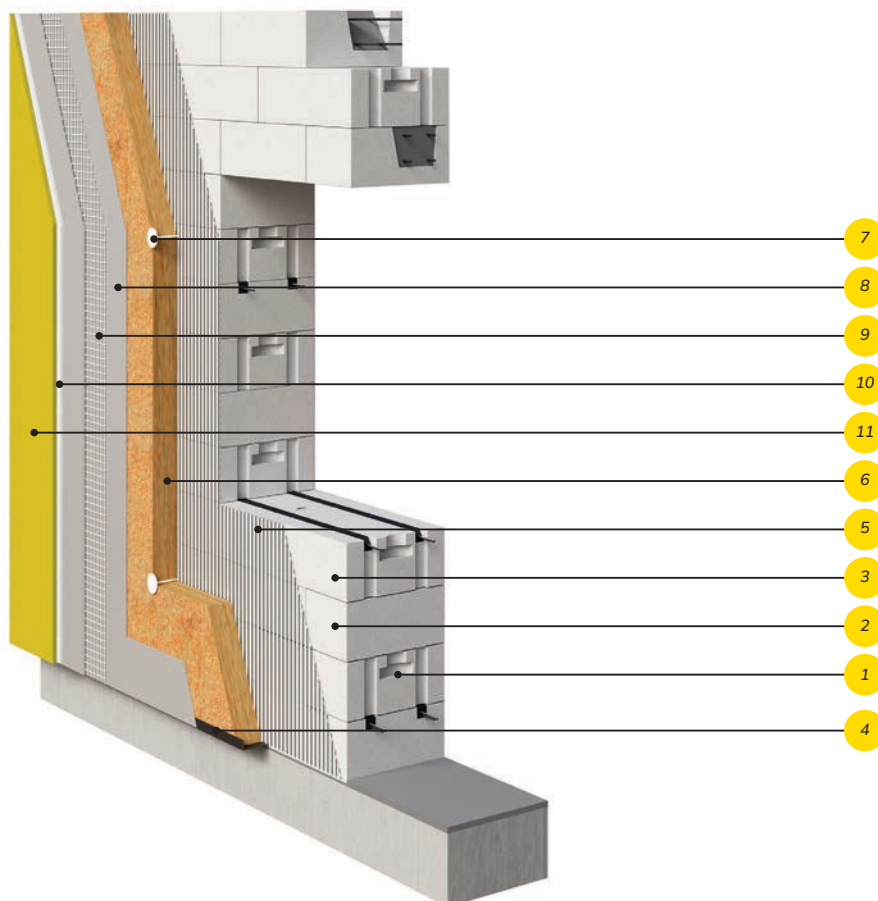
Схема теплоізоляції ТМ «UDK WALL SYSTEM» з мінераловатним (пінополістирольним) утеплювачем
